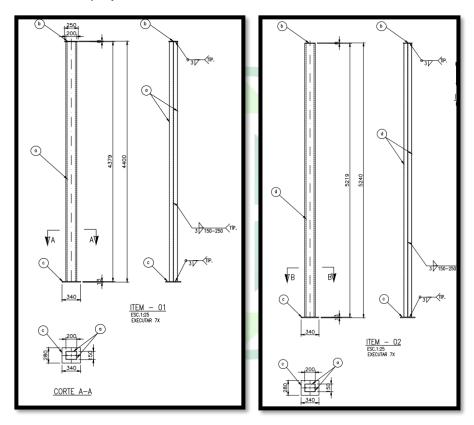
Detalhamento dos pilares metálicos em perfil U enrijecido
